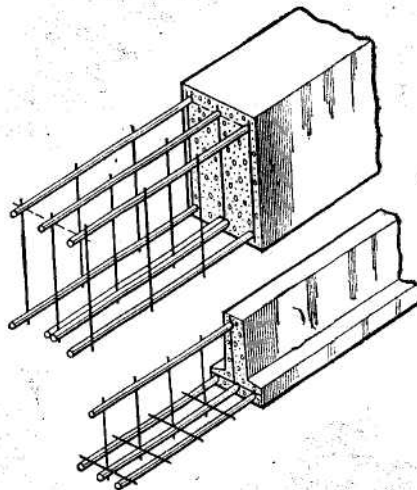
Армування балок плоскими зварними каркасами
